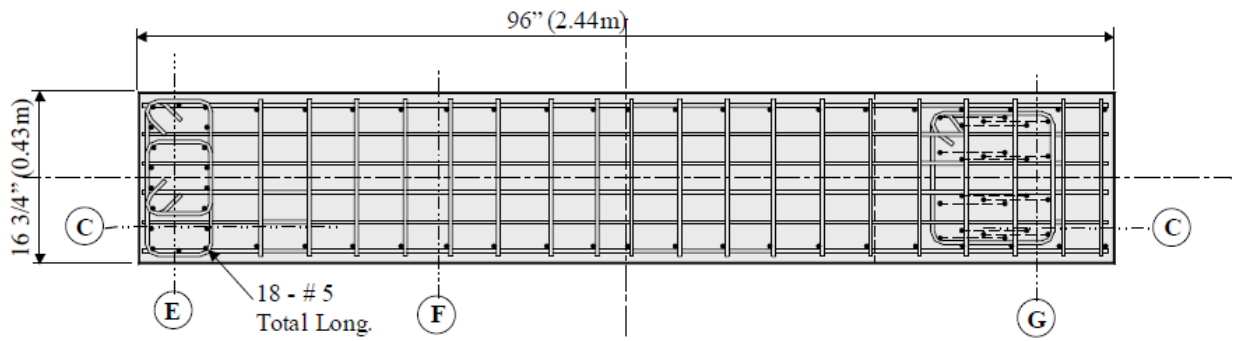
Vista en Planta de Refuerzos – Serie 2 Externa (Megally et al., 2002).
